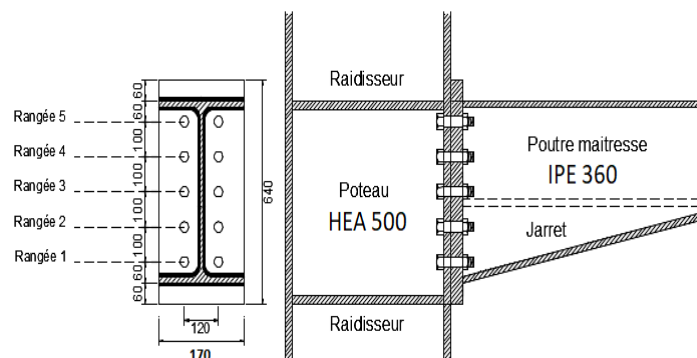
Détails de l'assemblage Poteau-Poutre maitresse.
